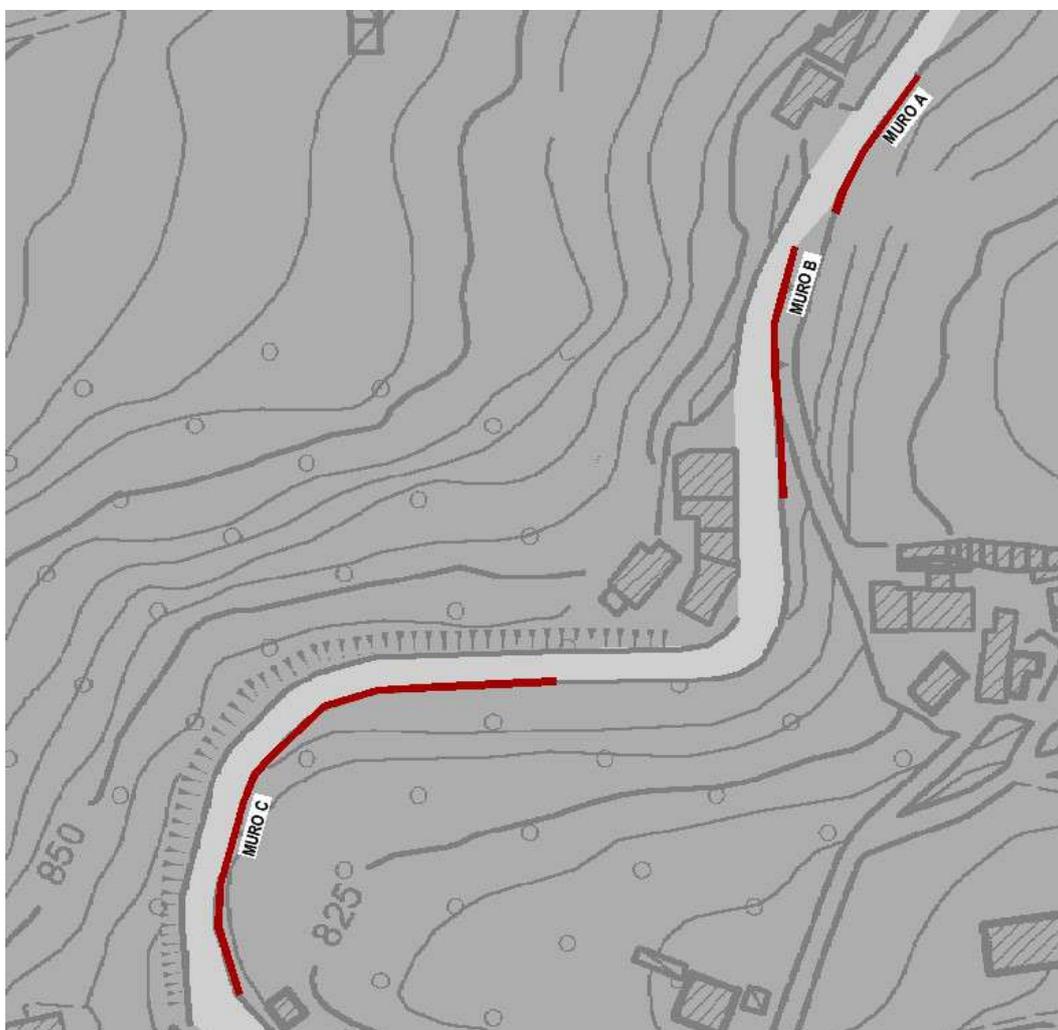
CTR con individuazione dei tre muri di valle oggetto di intervento
